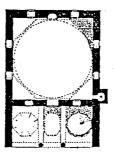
مسقط أفقي لدار الحديث في أدرنه (عن : أصلان ابا) .
